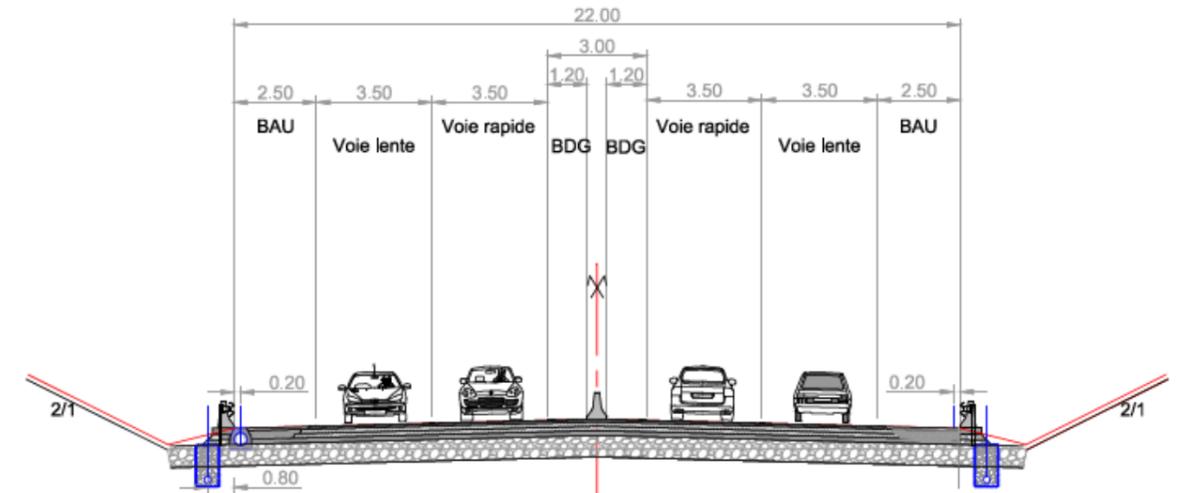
Profil en travers type de la section courante en configuration déblais – chaussée neuve
